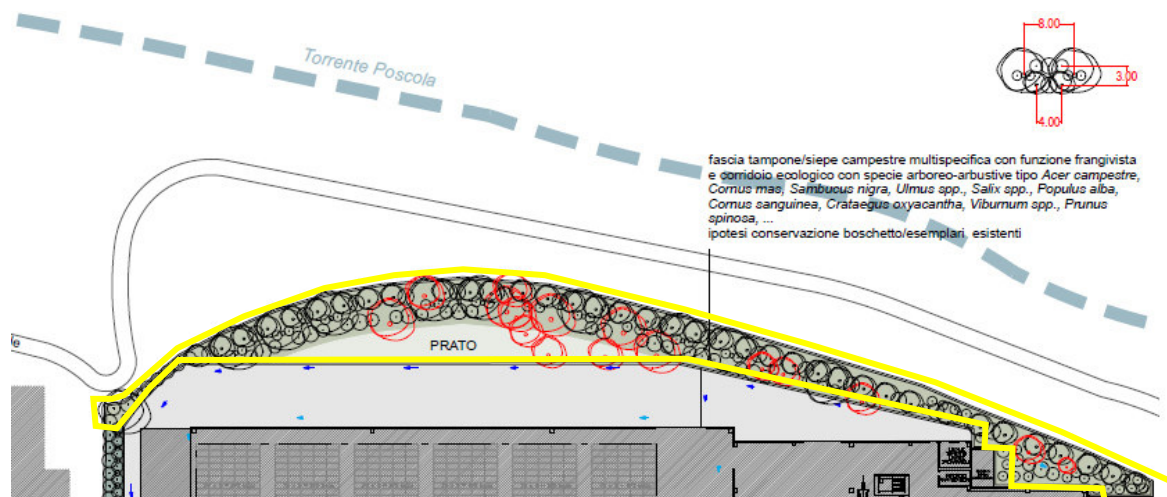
Estratto planimetrico progetto del verde – Stralcio 1 evidenziato in giallo.
